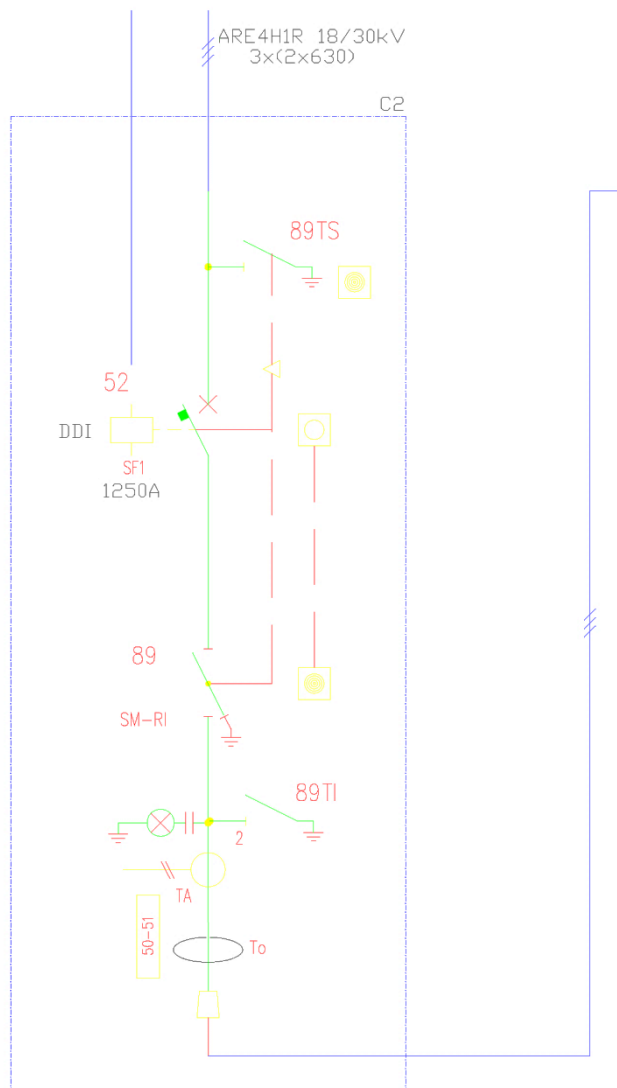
PARTICOLARE DI SCHEMA DELLA CABINA DI PARALLELO
